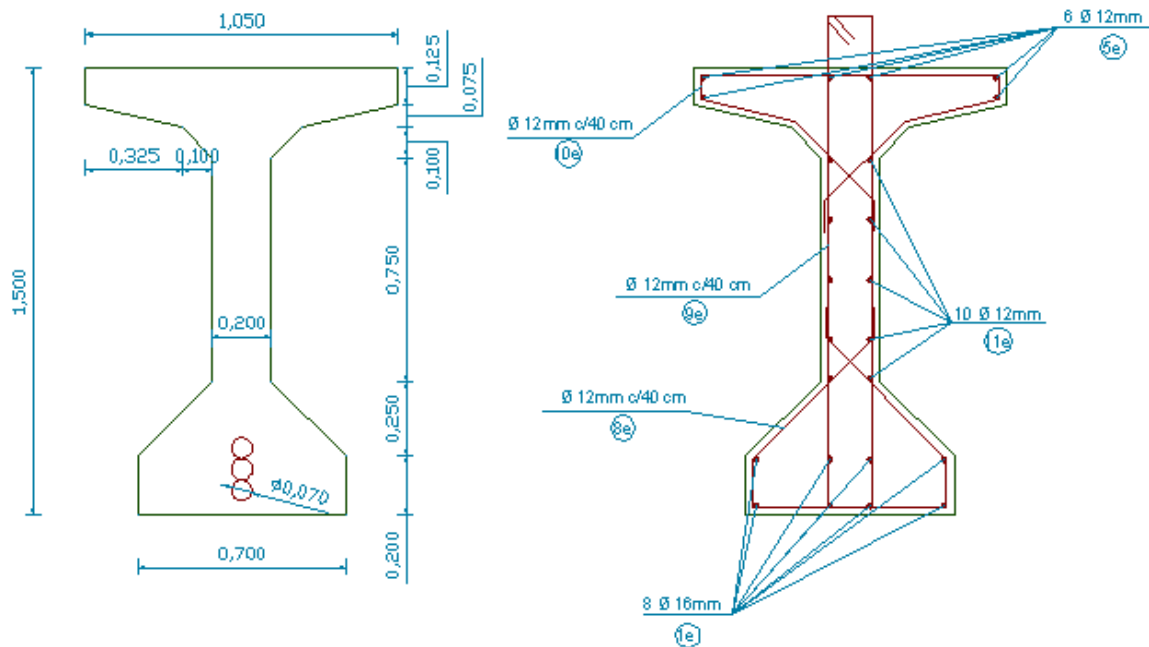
Geometría de la viga postensada y armadura en centro luz.
